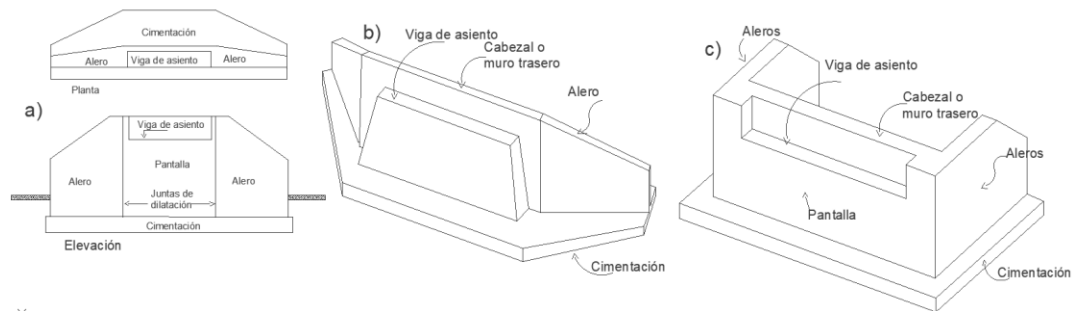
2 a) Estribo recto y aleros rectos, b) Estribo con aleros en ángulo, c) Estribo en U
